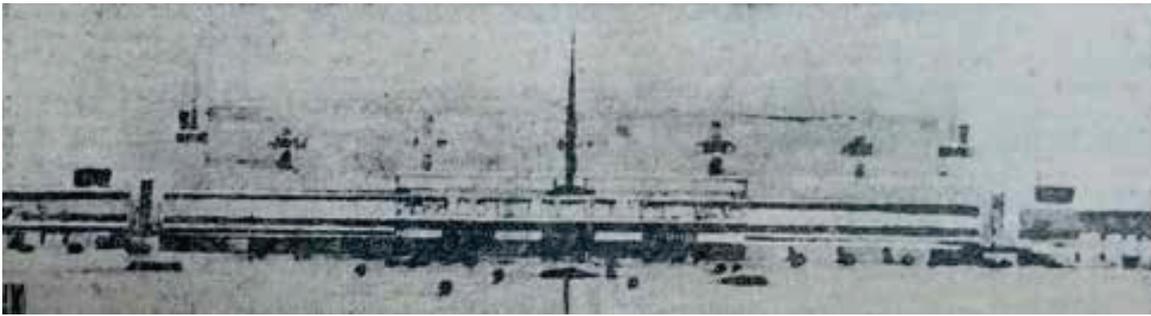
PRIMER PREMIO, FACHADA DEL PROYECTO CON EL LEMA «DEJALA, JUAN!».
